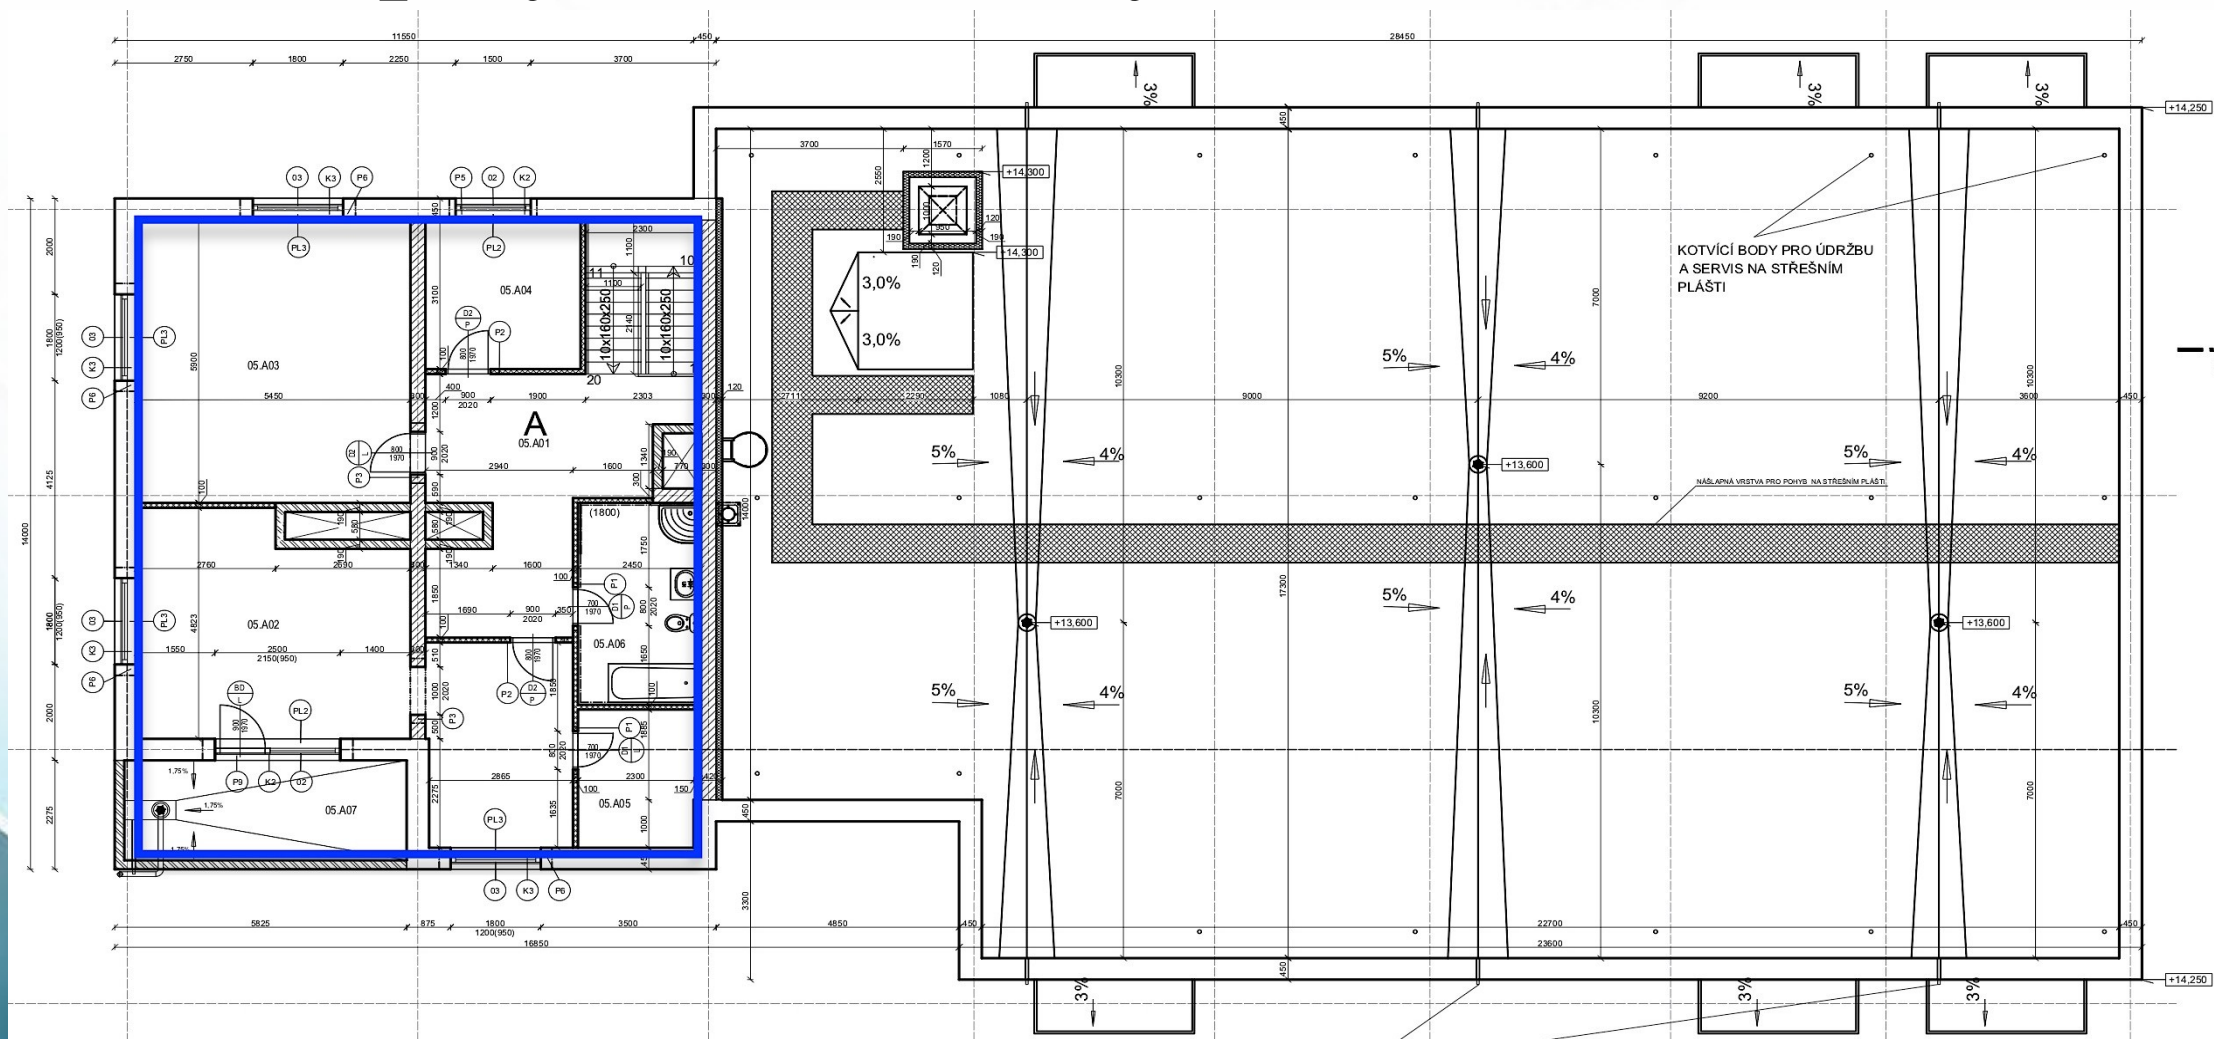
Půdorys 3.NP, zdroj: vlastní
